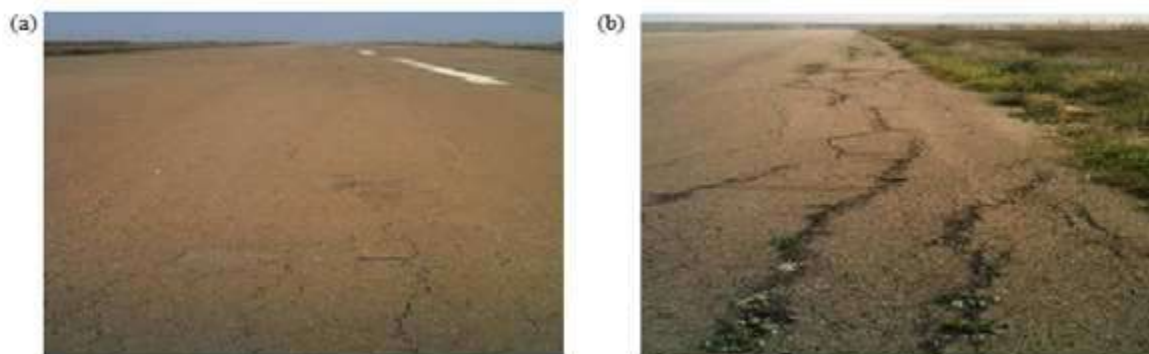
Dégradation de la chaussée de la piste 12/30 : (a) faïençage de fatigue ; (b) Fissures de gravité élevée avec poussée d'herbes (CTTP Tébessa 2007).
